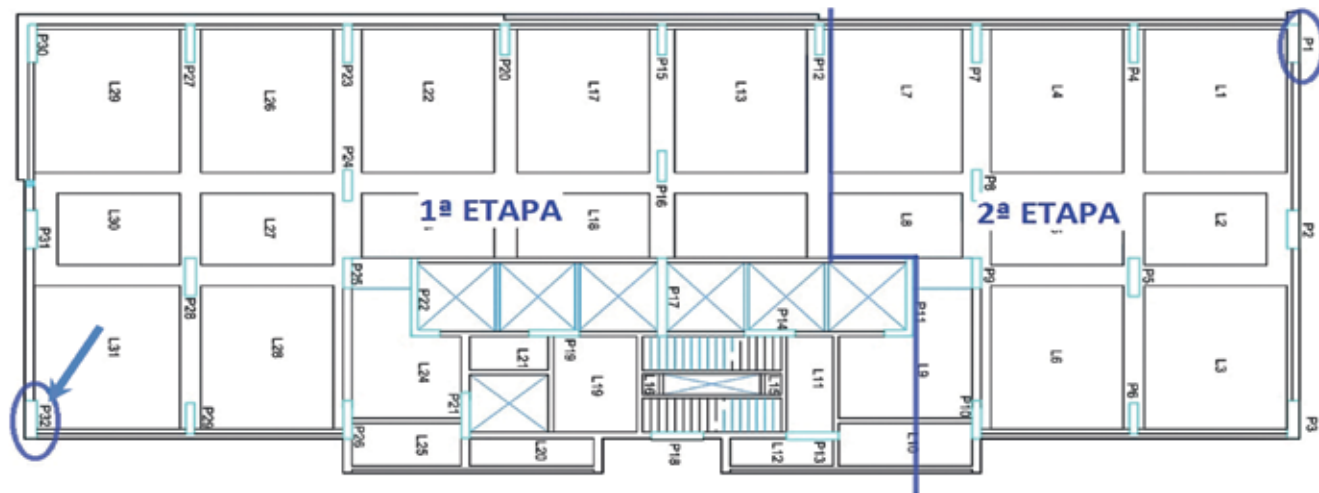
Pavimento-tipo dividido em duas etapas de execução
